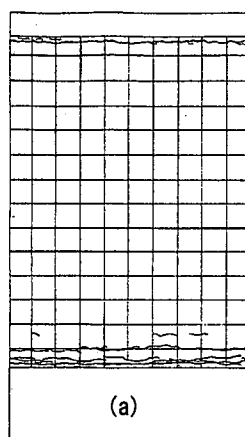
岩着試験体のひび割れ状況（東側壁）
